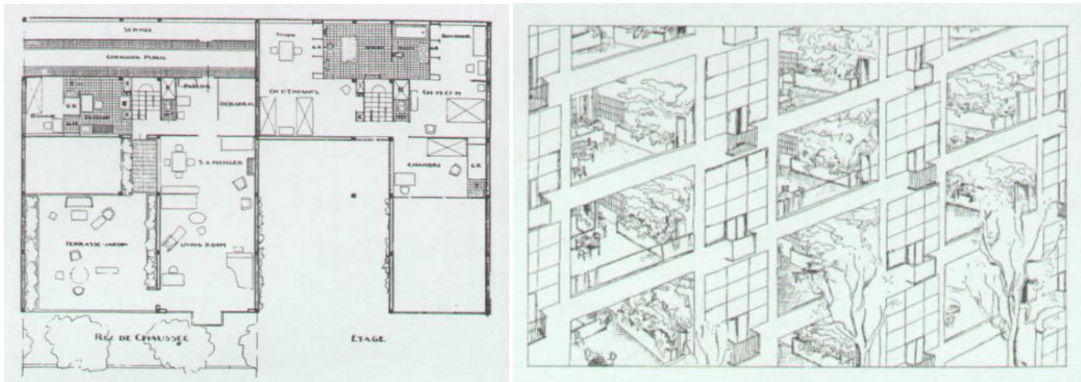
e Figura 14 - Células de habitação de Le Corbusier – planta e vista parcial da fachada. (Capitel, 2005, p. 163)
